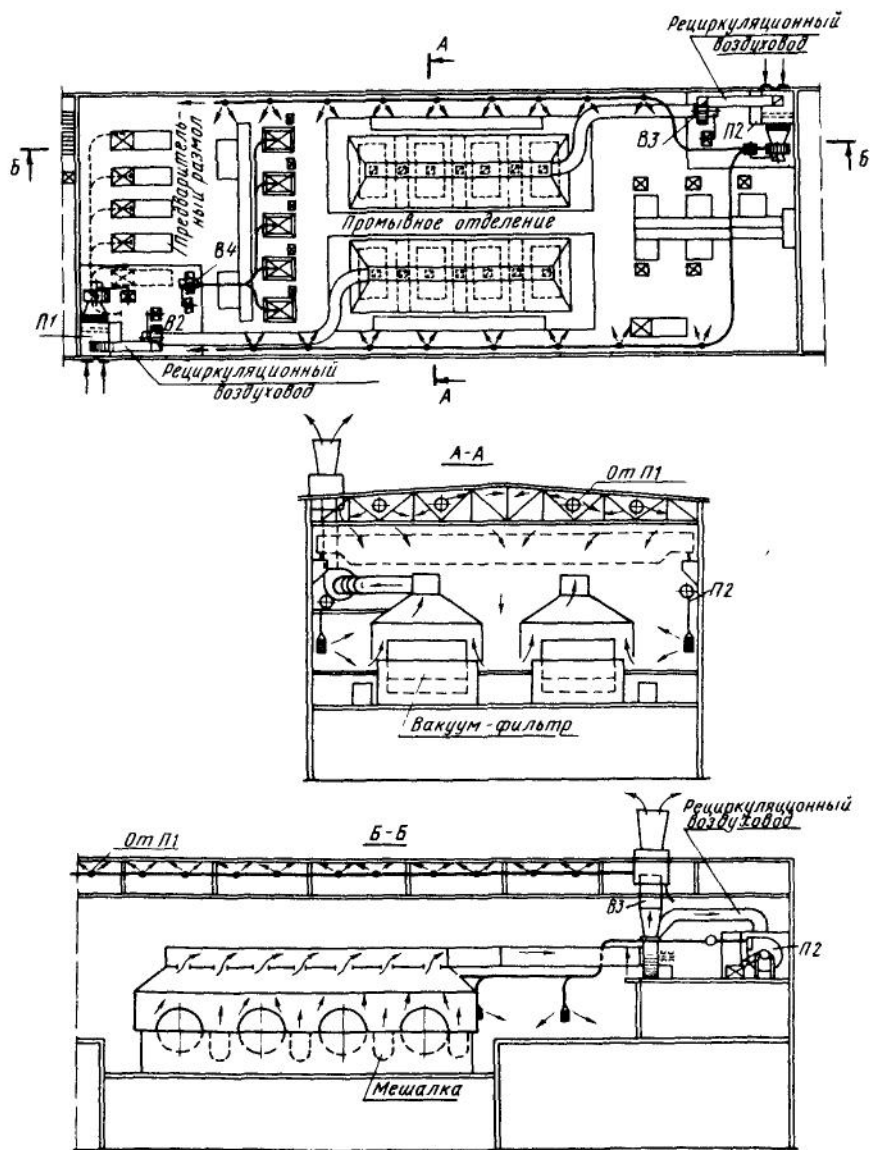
План, продольный и поперечный разрезы промышленного здания (П — приточная установка, В — вытяжная установка)
